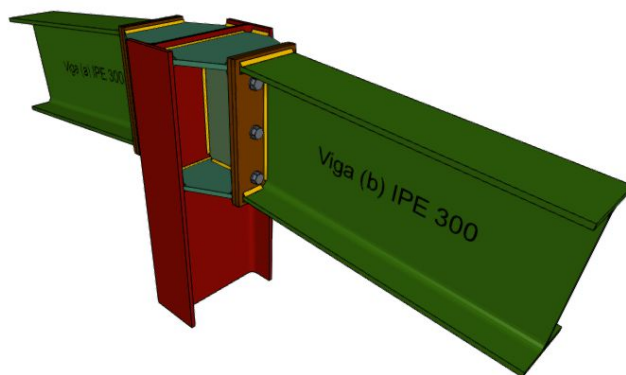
Unión articulada pilar central-dinteles pórtico fachada
